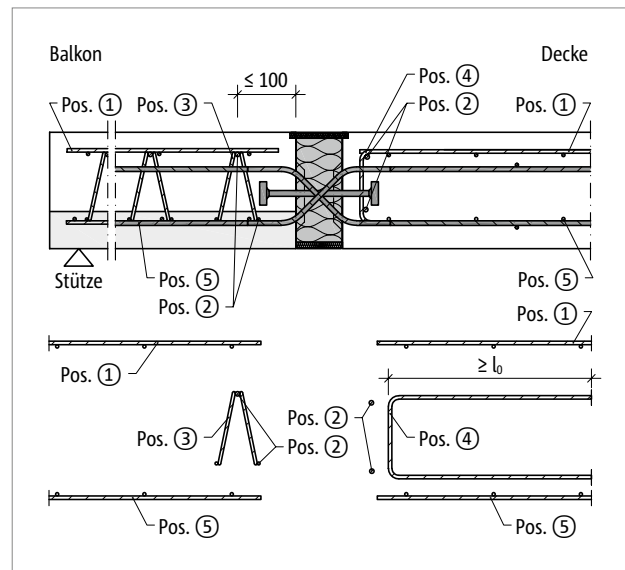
Schöck Isokorb® T Typ QP: Bauseitige Bewehrung, balkonseitig mit Gitterträger
